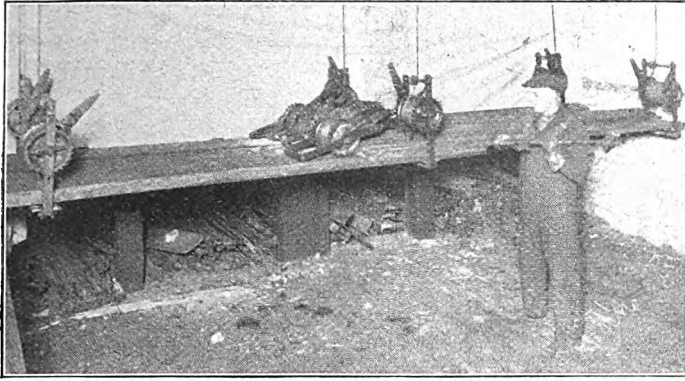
/8. Versuchsweise Zerstörung einer Schnellbauerrüstung. Die gußeisernen Teile des Windwerkes werden mit dem Hammer zer-
